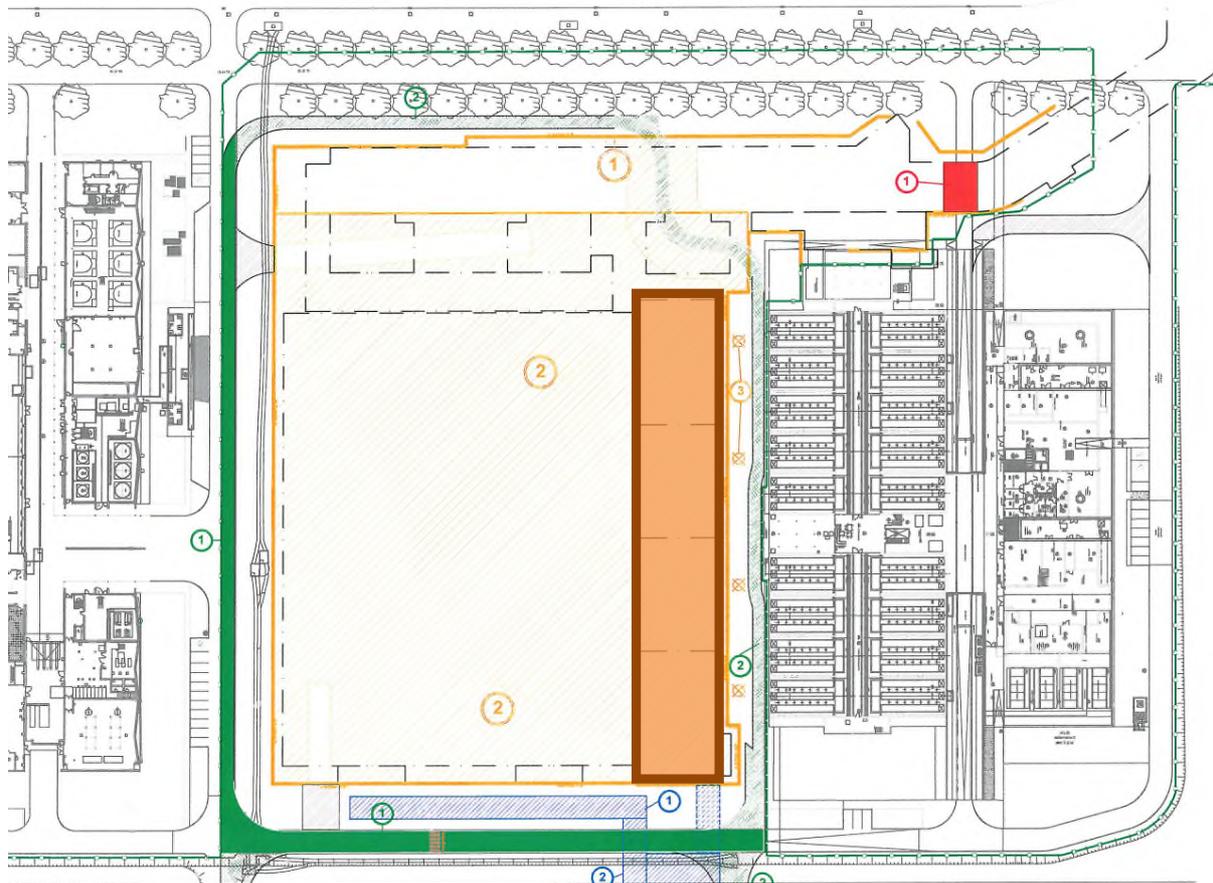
Emprise terrassée zone Biofiltration pour laquelle un rabattement est nécessaire
